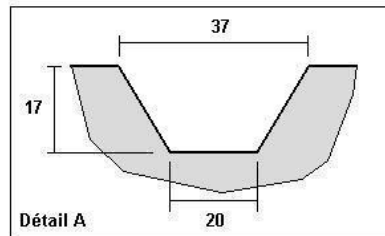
Panneaux à bossage Type 2 (dimensions en mm)
